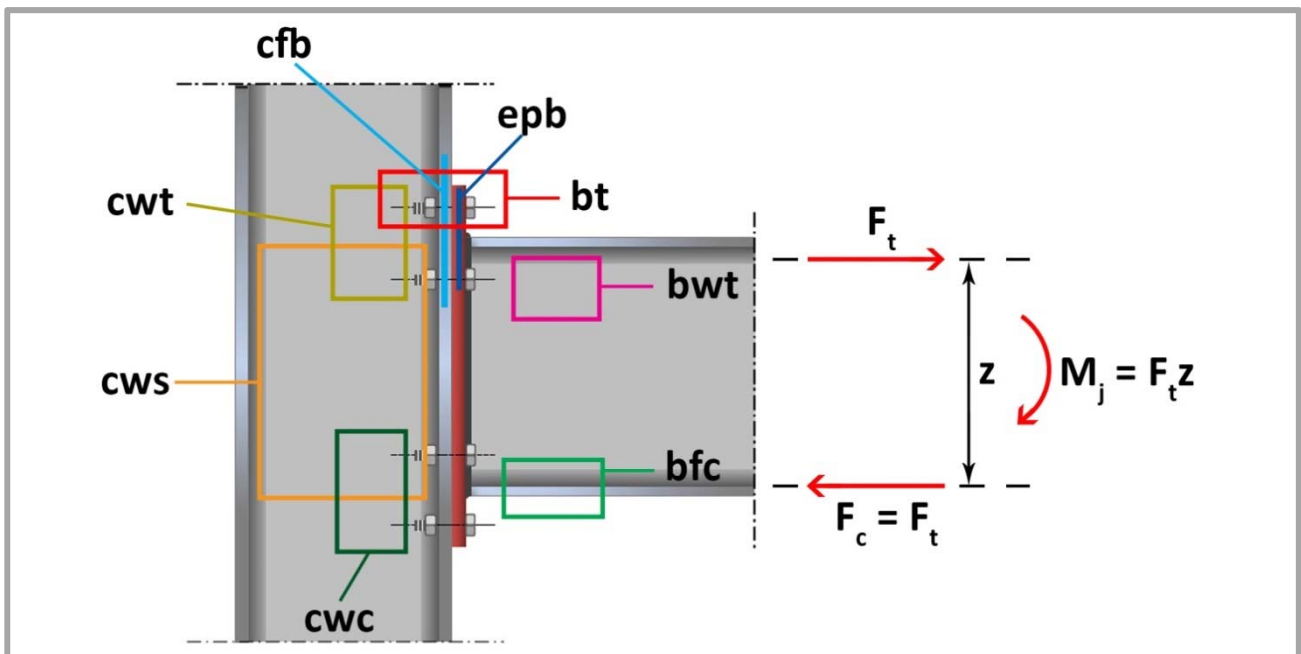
Schema delle componenti di un nodo trave-colonna con collegamenti bullonati
